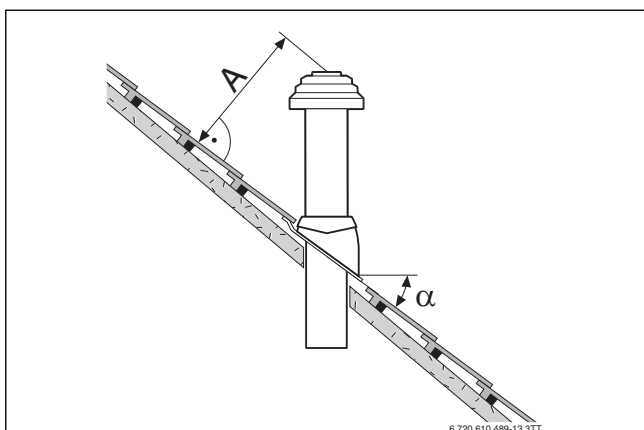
Abstandsmaße und Dachneigungen bei Schrägdach
